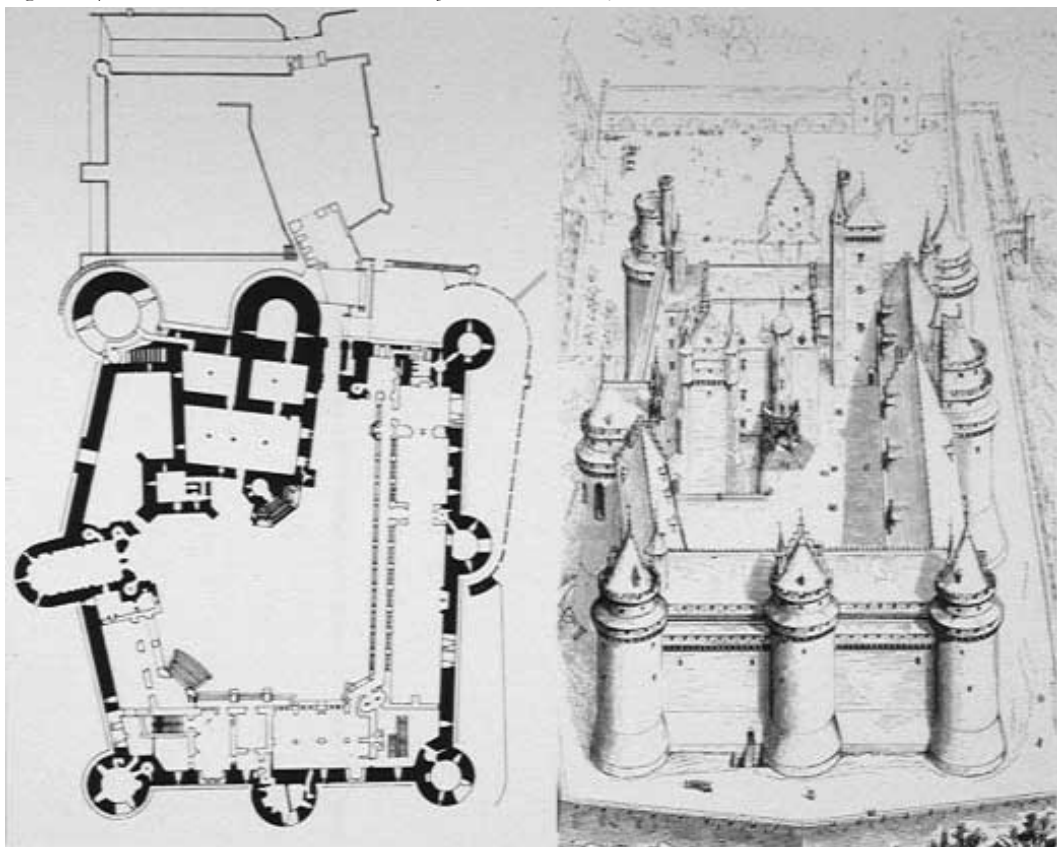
| Viollet - Le - Duc *Le château de Pierrefonds* - proposta de intervenção
